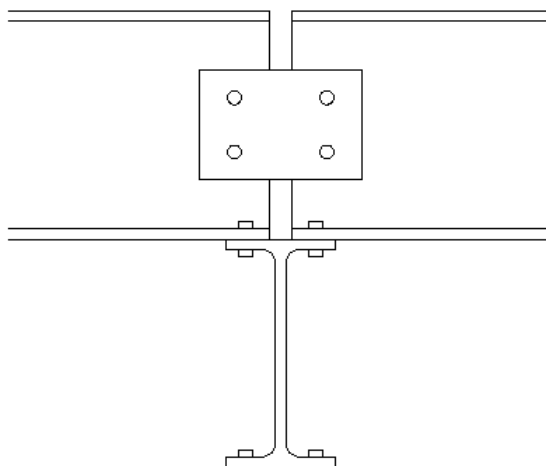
Conexión entre viga secundaria B y superficie de rodadura y conexión de bastón
